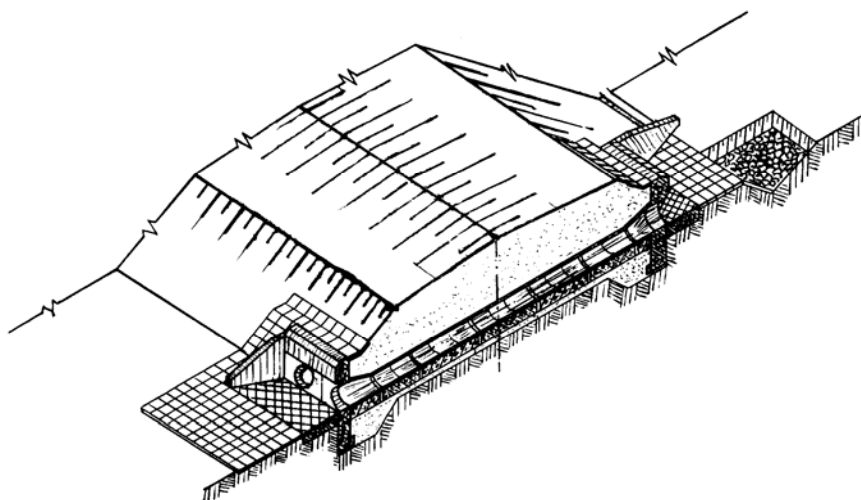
Конструкция двухочковой железобетонной трубы
